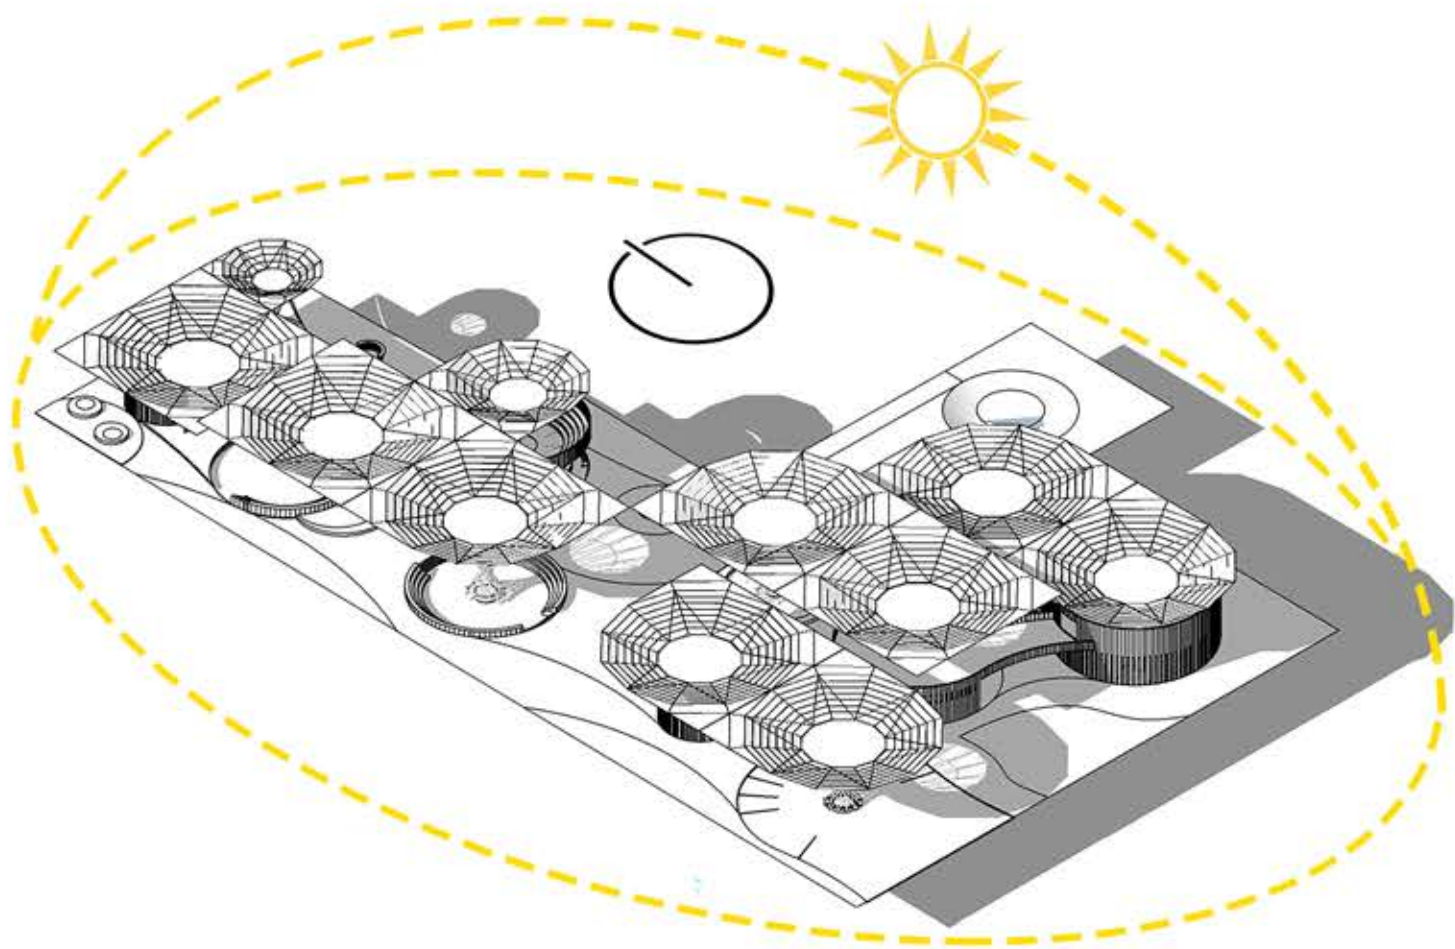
Bedoya David (2021) Sección Constructiva 3D (imagen44.png)
